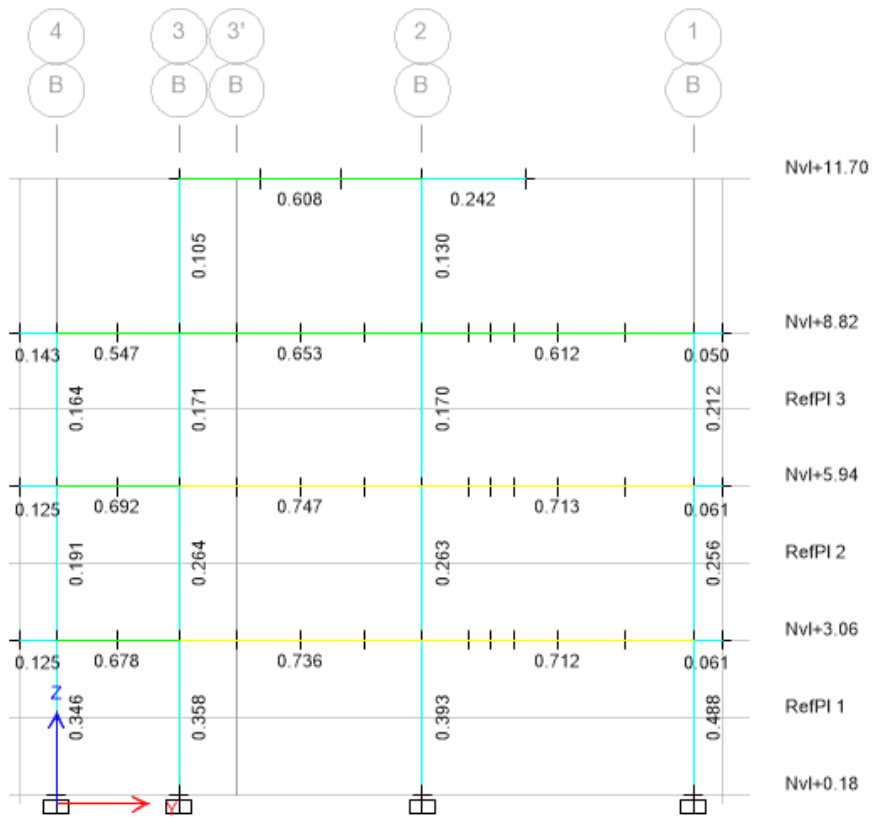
Diseño de columnas huecas, vigas principales del eje B
